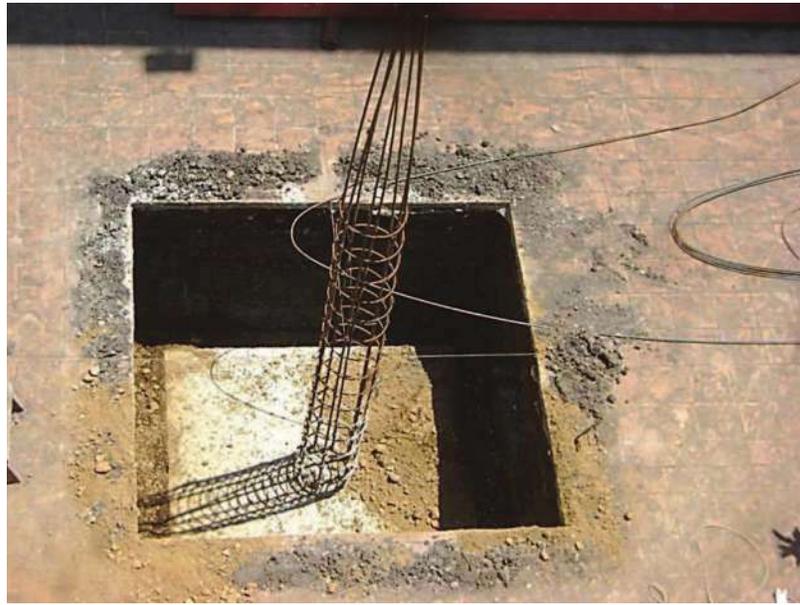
Se observa la zapata colada y el habilitado de acero del dado.
